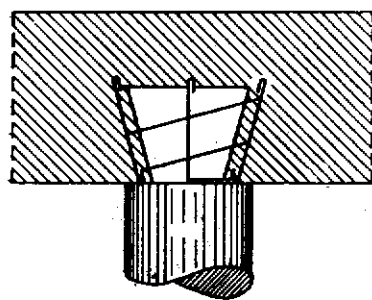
Fixarea fundației pe capătul unui pilot din lemn.
